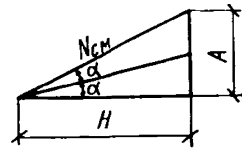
К расчету опорного сечения верхнего пояса фермы
